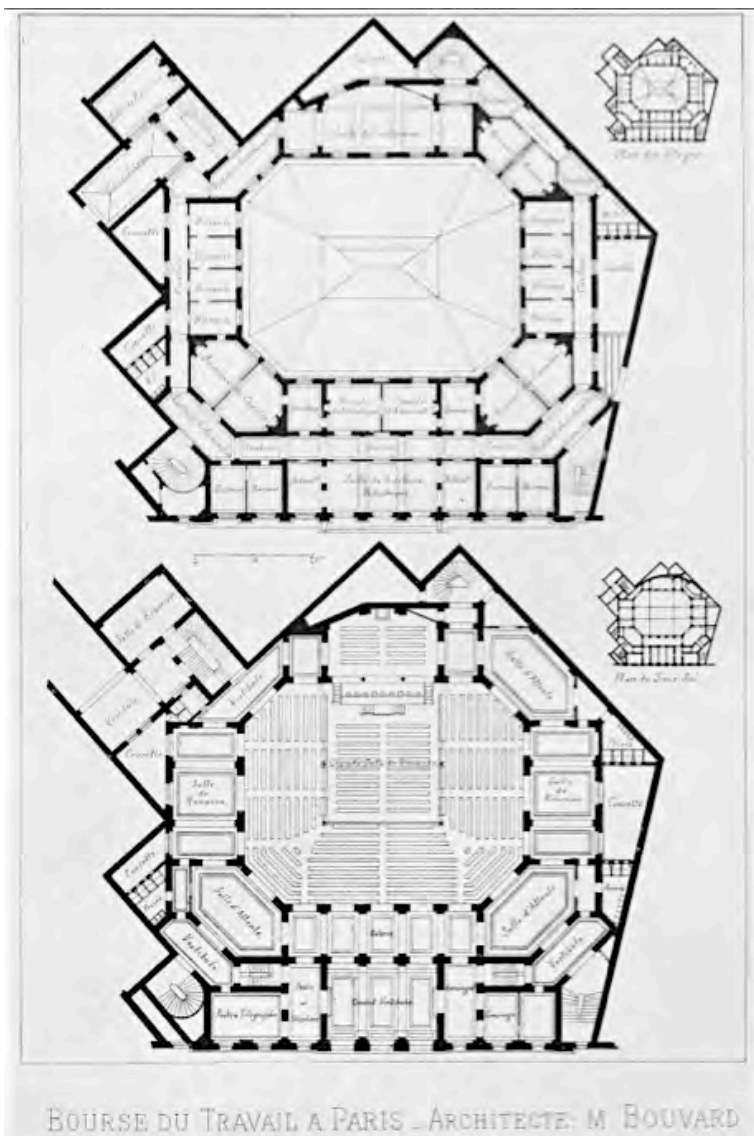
La Bourse du Travail. Plantas. (Fonte: La Construction Moderne, CM-1890-08-LA BOURSE DU TRAVAIL, 1890)
